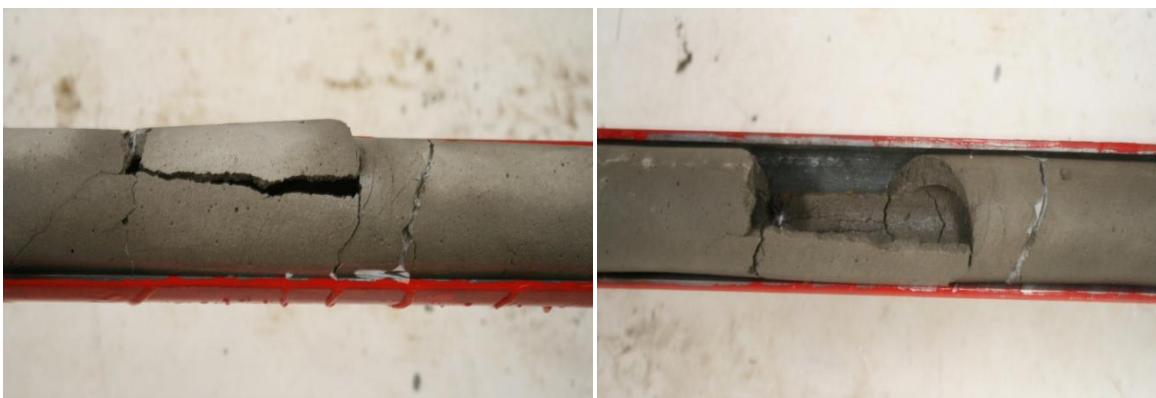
Izquierda: Ruptura y levantamiento de la clave del tubo. Derecha: Falla del tubo vista en planta.
